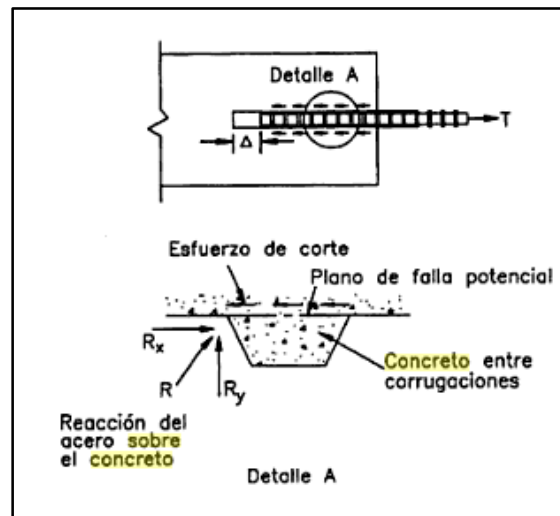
Falla del concreto entre corrugaciones de las varillas de acero.
